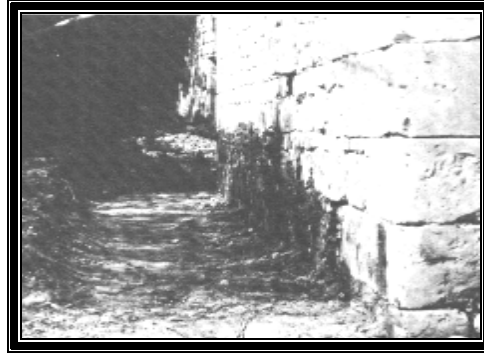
tranchée ouverte autour d'une bâtisse
